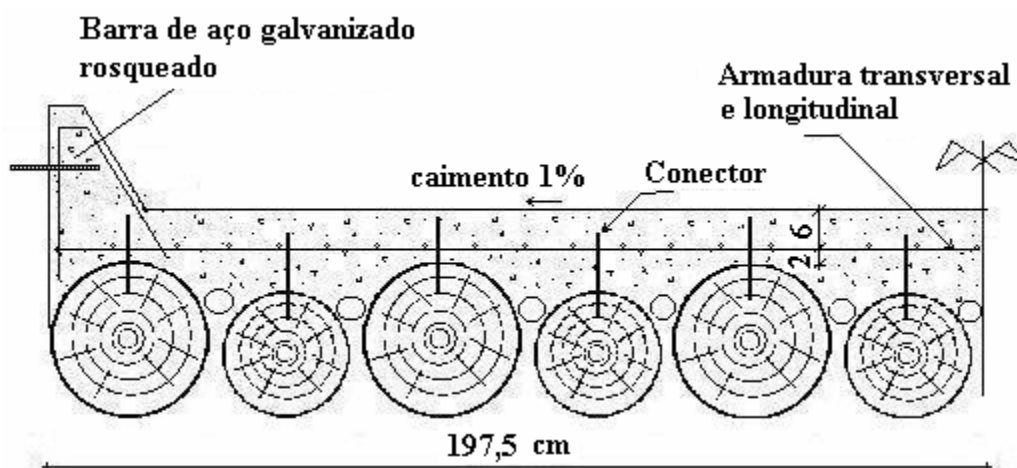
Seção transversal adotada para a Ponte “Florestinha”. Fonte: Pigozzo (2004).
